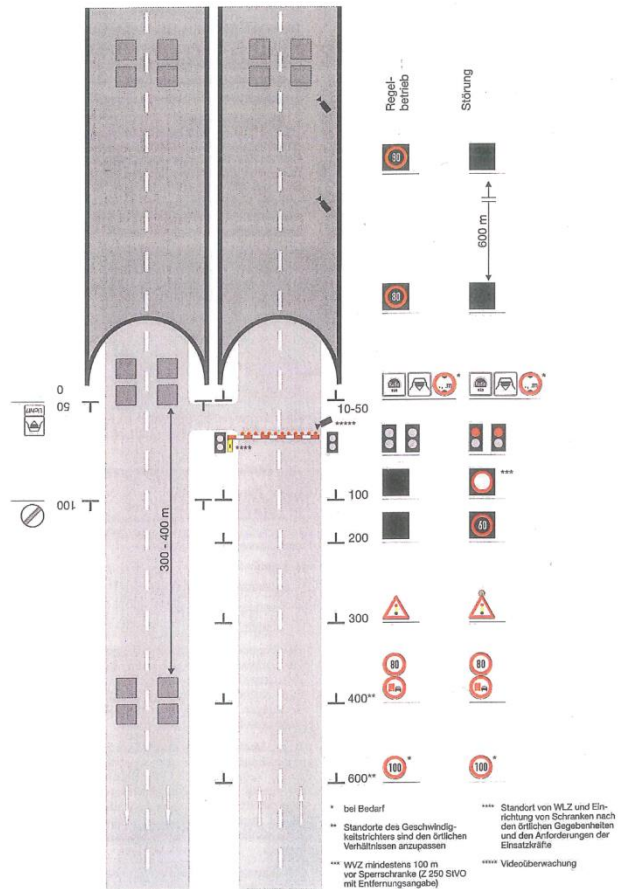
Grundausrüstung – Systemskizze bei Richtungsverkehr (sinngemäß auf Gegenverkehr zu übertragen)
